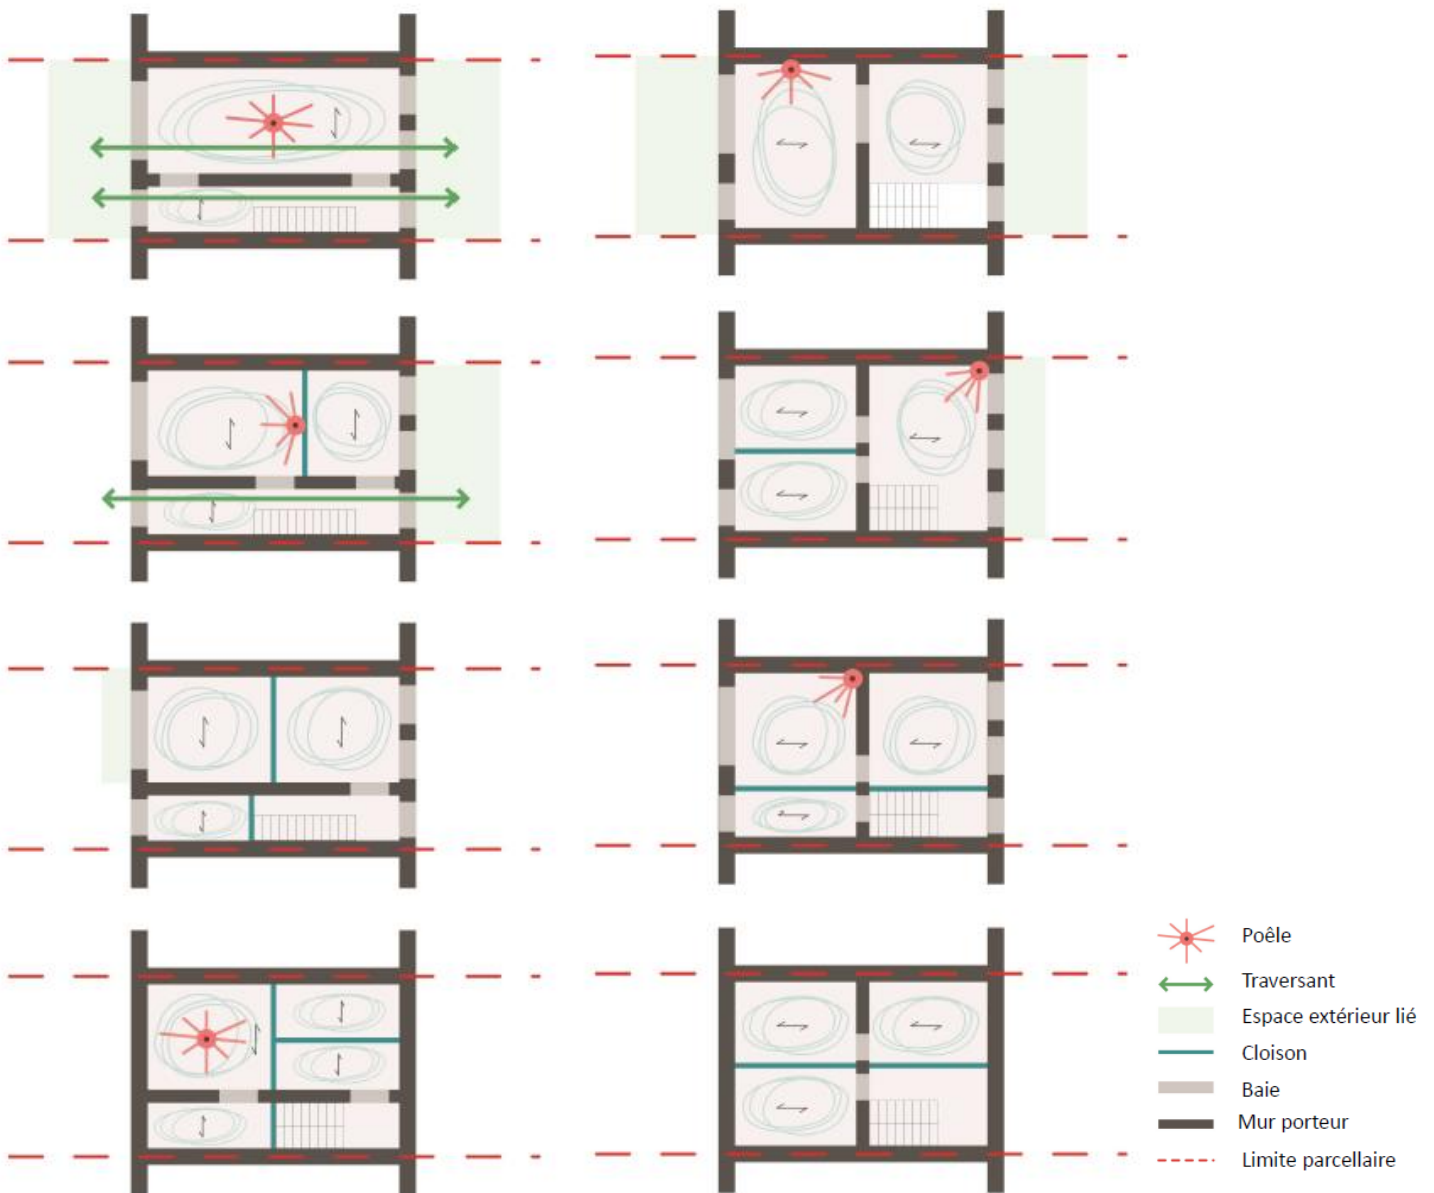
Plans de principes d'aménagement d'une maison mitoyenne en fonction des murs porteurs - Groupe B, 2022
